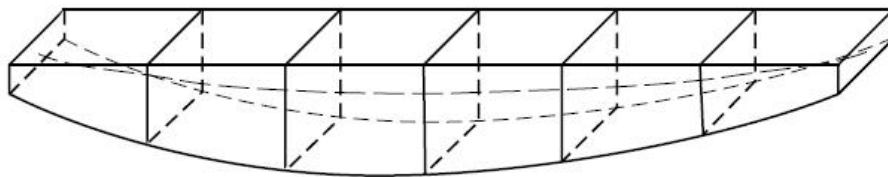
Exemple de poutre à section variable (utilisée à Jussieu pour supporter les étages) (Boucard, 2007)
